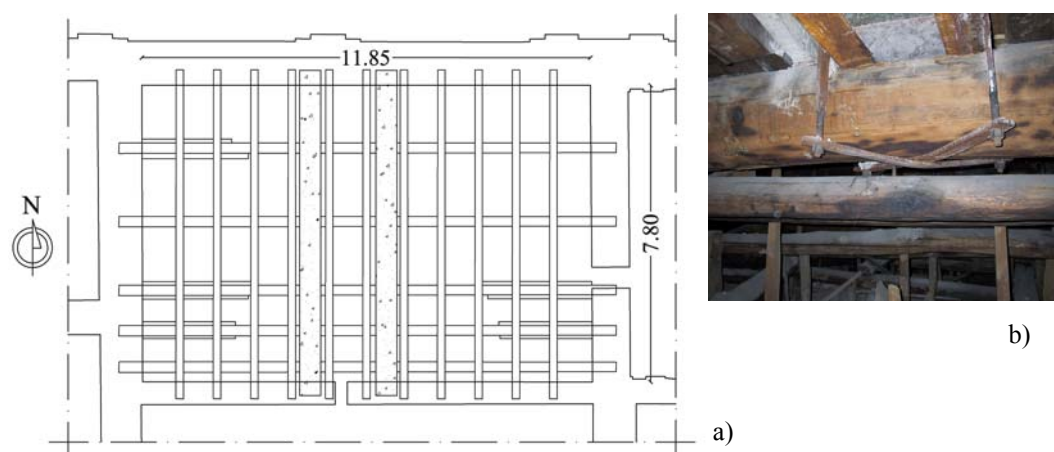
Pianta solaio Sala XXIV: a) Orditura solaio; b) Particolare dell'intervento.
